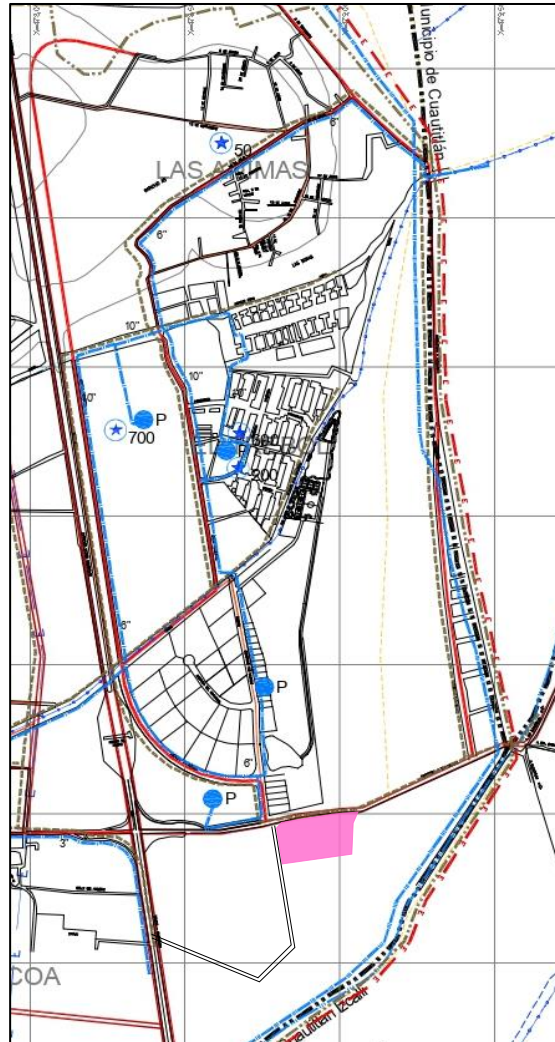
Plano de infraestructura actual (hidráulica, drenaje y eléctrica).
